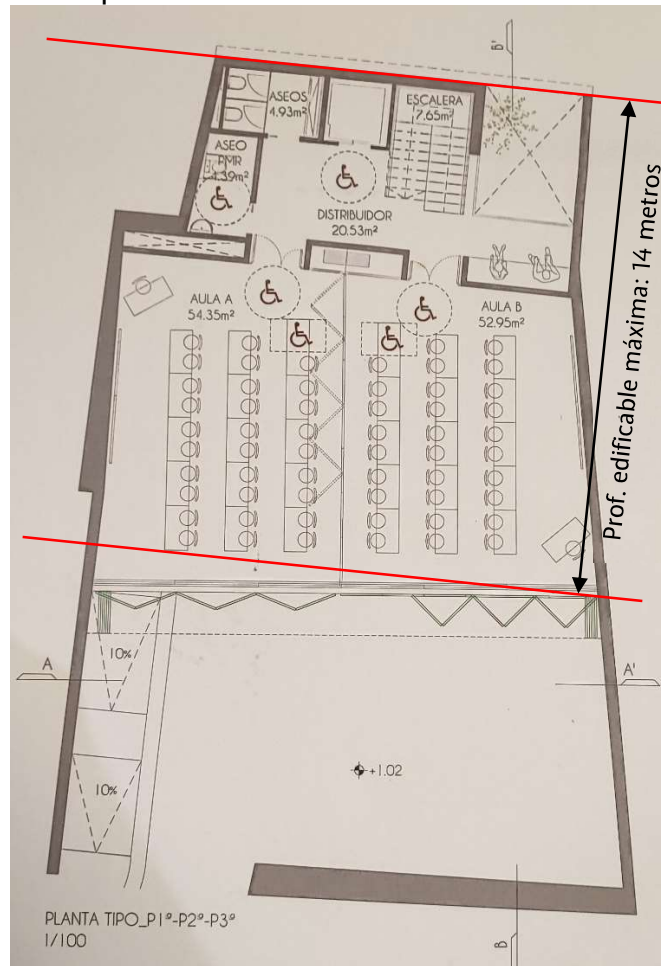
Detalle de la planta piso tipo en PLANTA TIPO\_P1°-P2°-P3° (escala 1:100) en la lámina 2/2 de la documentación presentada por el licitador.
